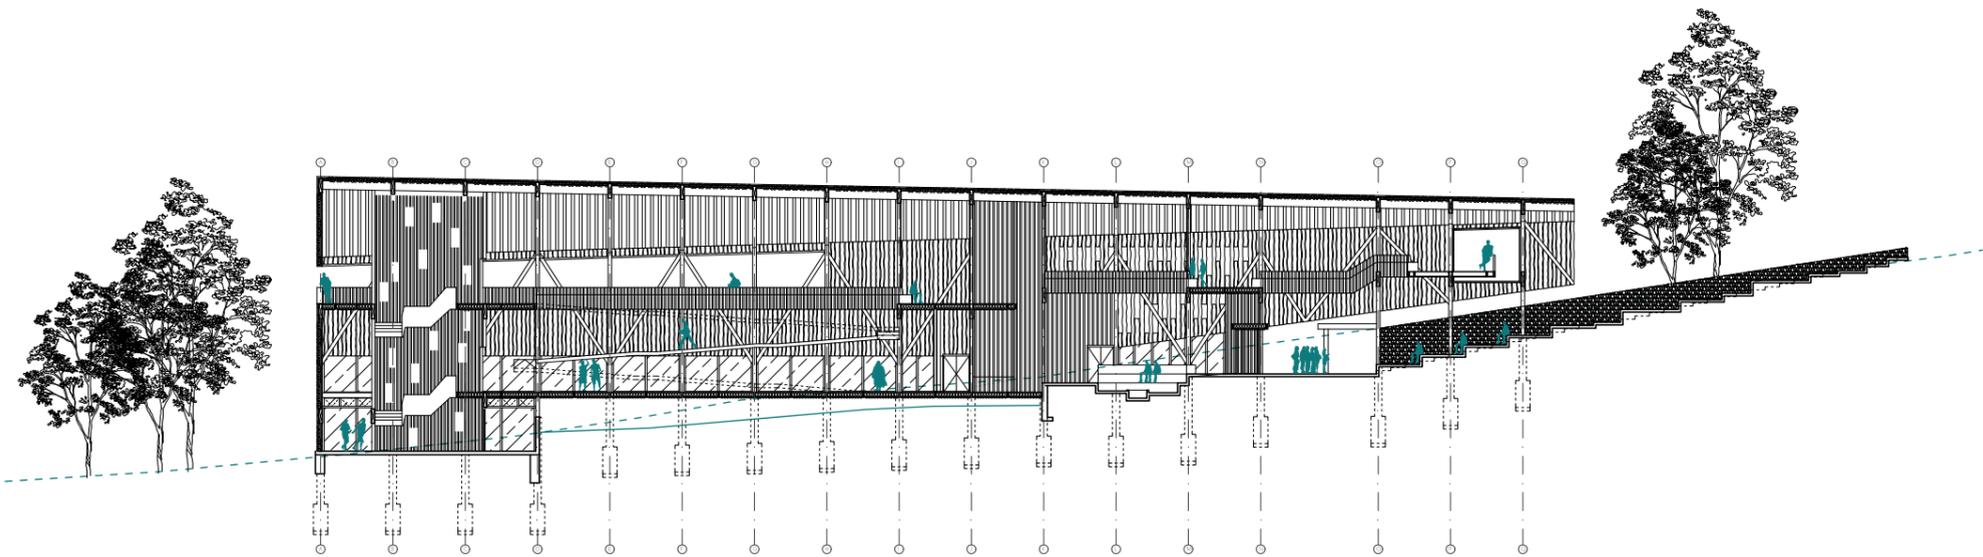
Planimetría desarrollada hasta la fecha del proyecto. Elaboración propia.
